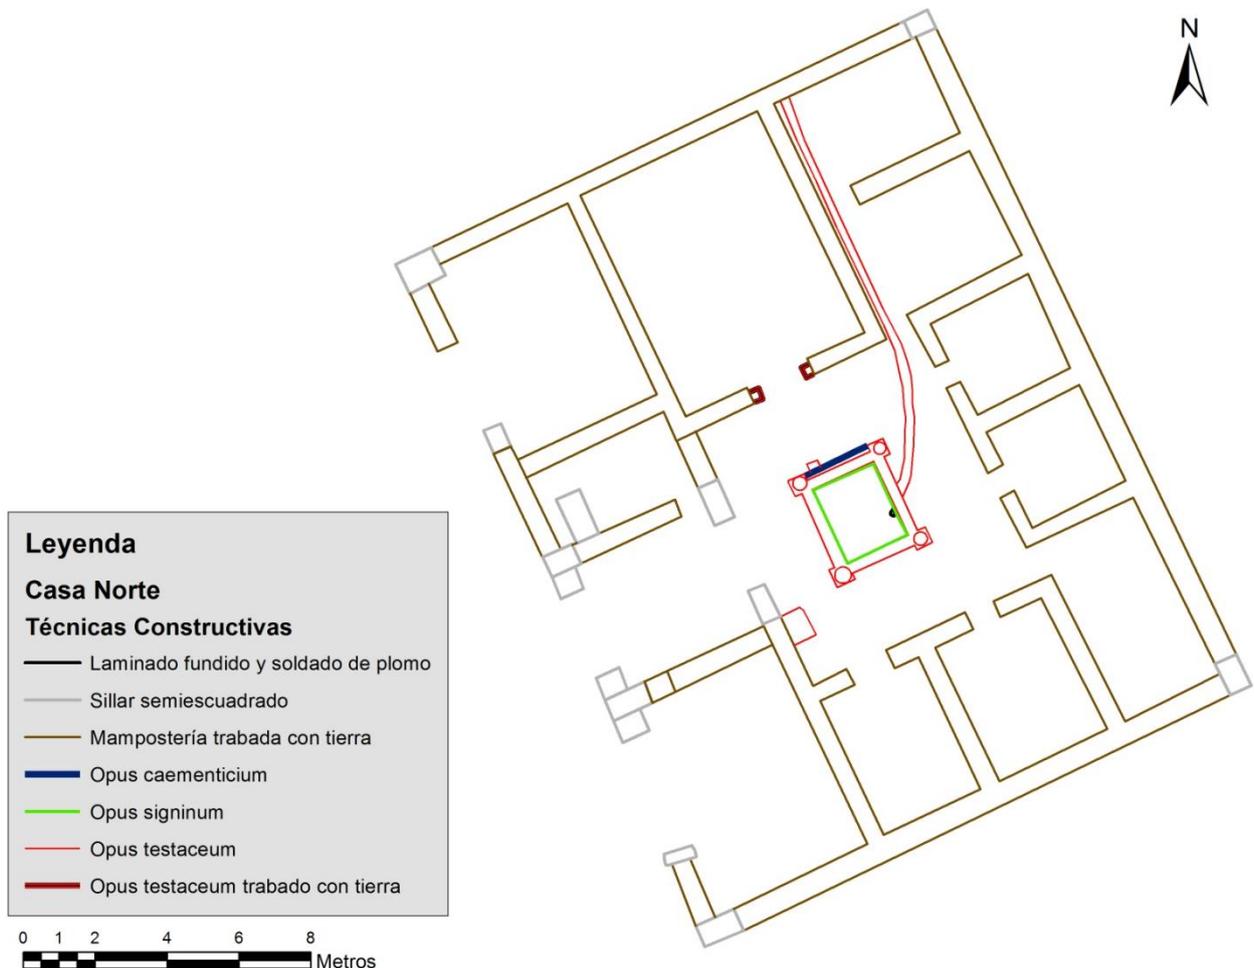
Plano que muestra las técnicas constructivas de la Casa Norte de su fase augustea.
